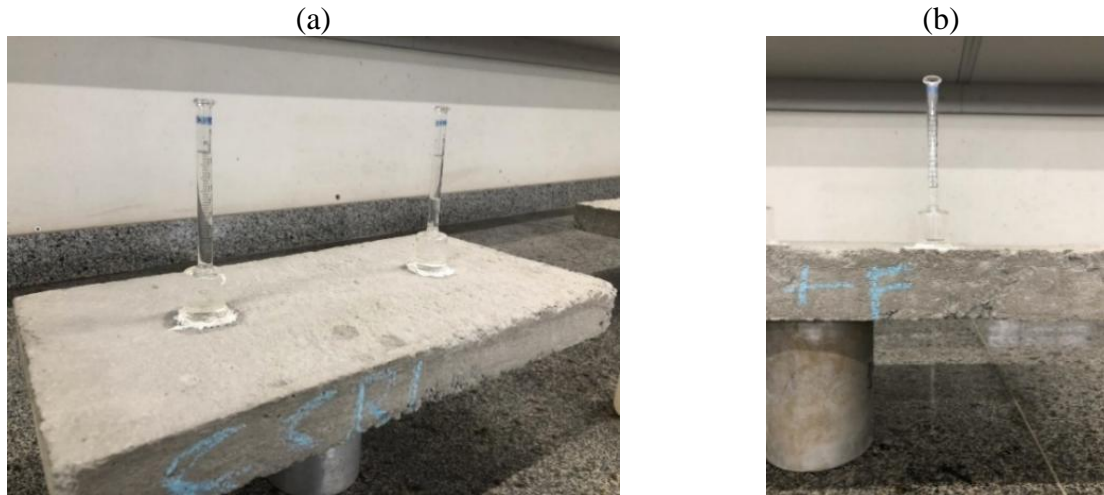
Tubos de Karsten fijado en los paneles: (a) Tubo en panel sin grieta, (b) Tubo en panel con grieta.
